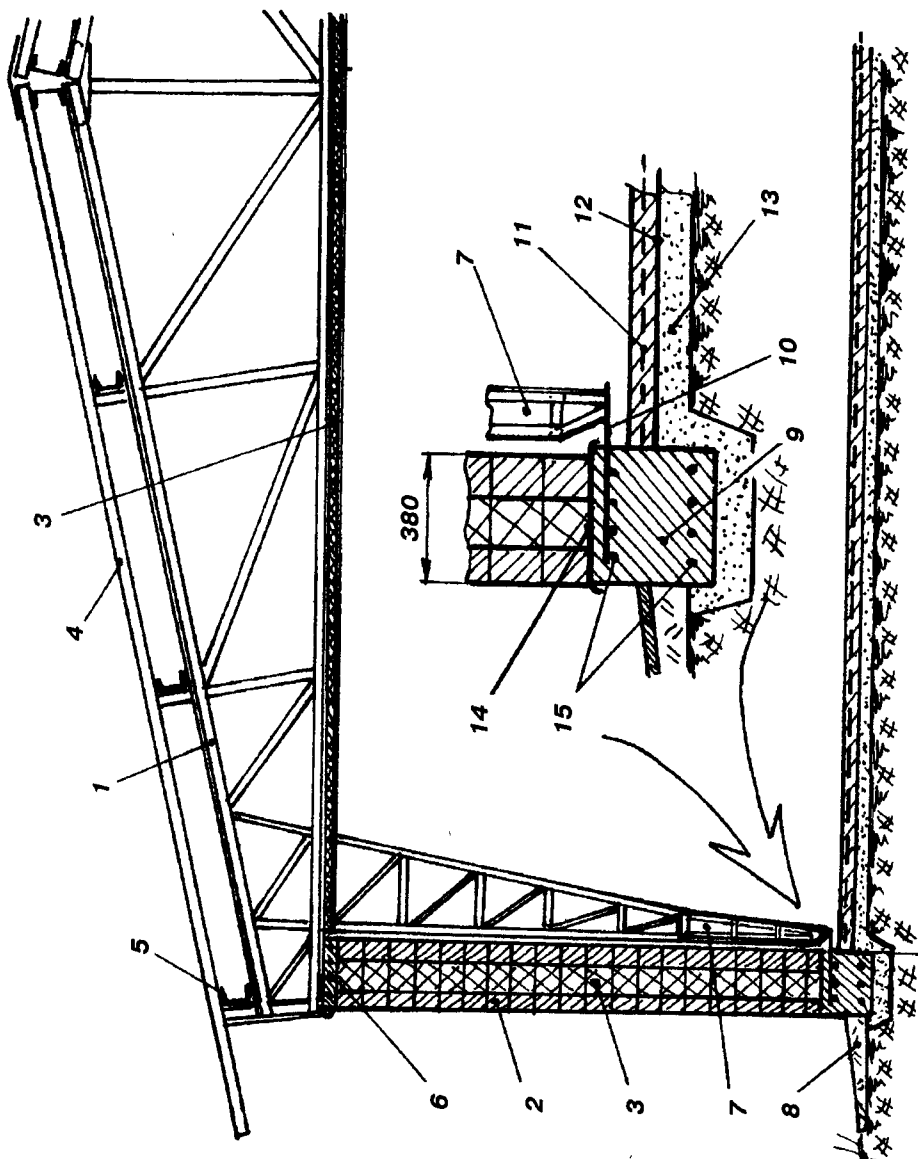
Каркас и фундамент здания с протяженными стенами (размеры в мм):
